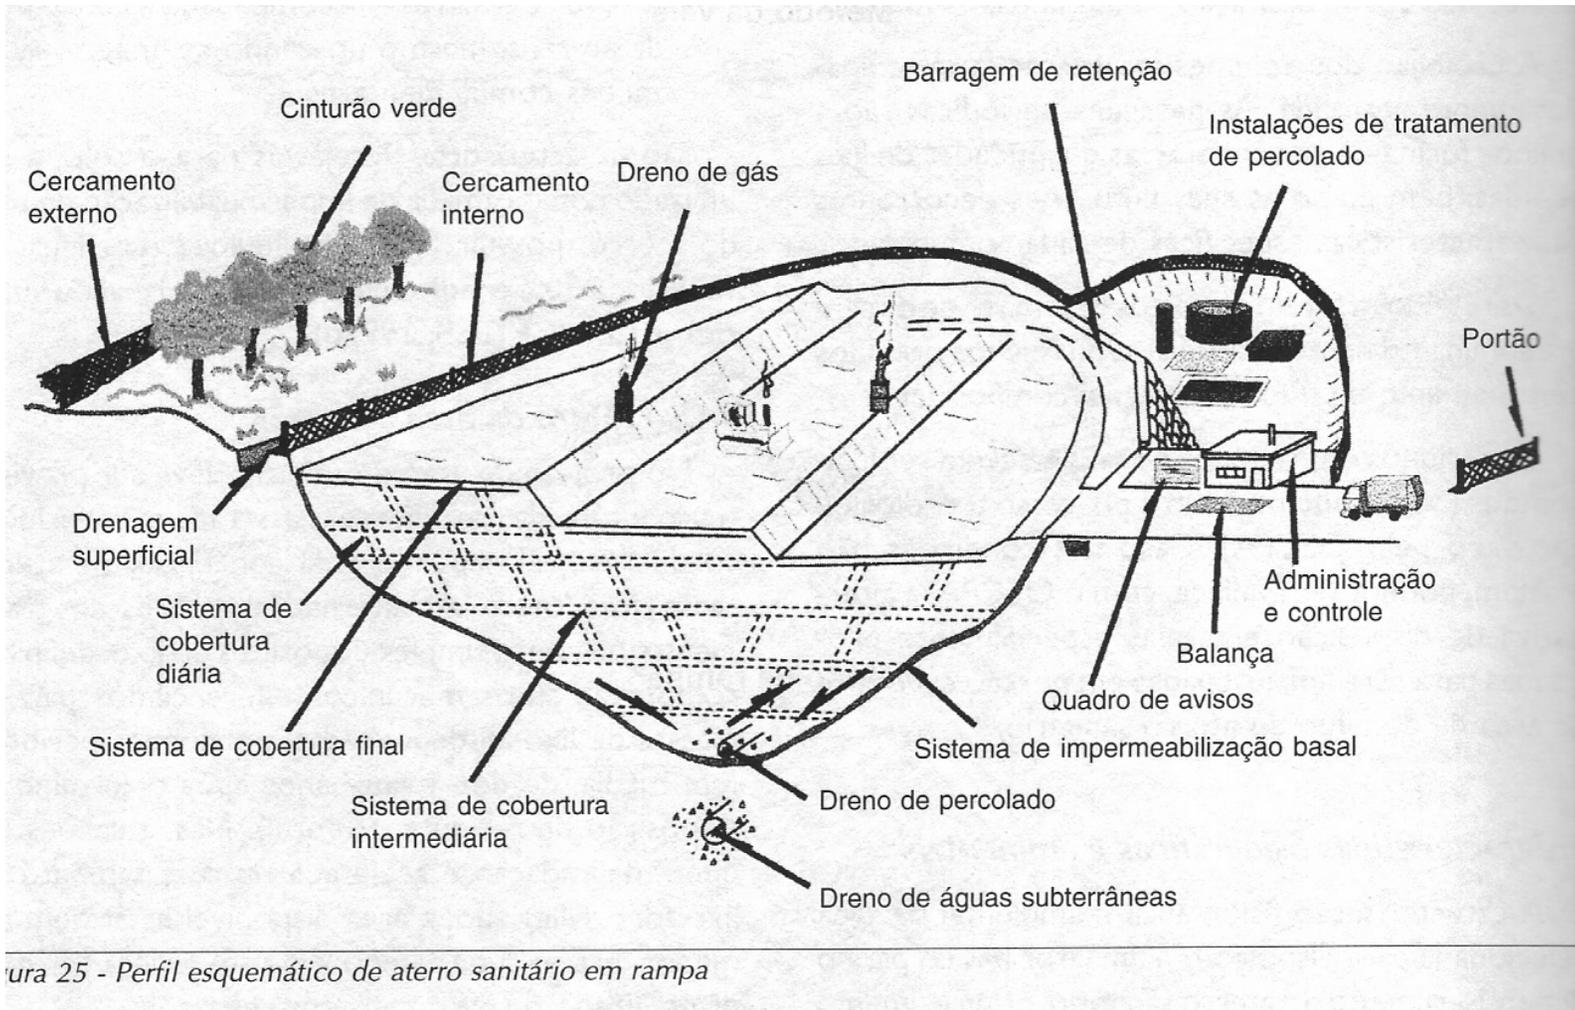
Perfil esquemático de aterro sanitário em rampa
